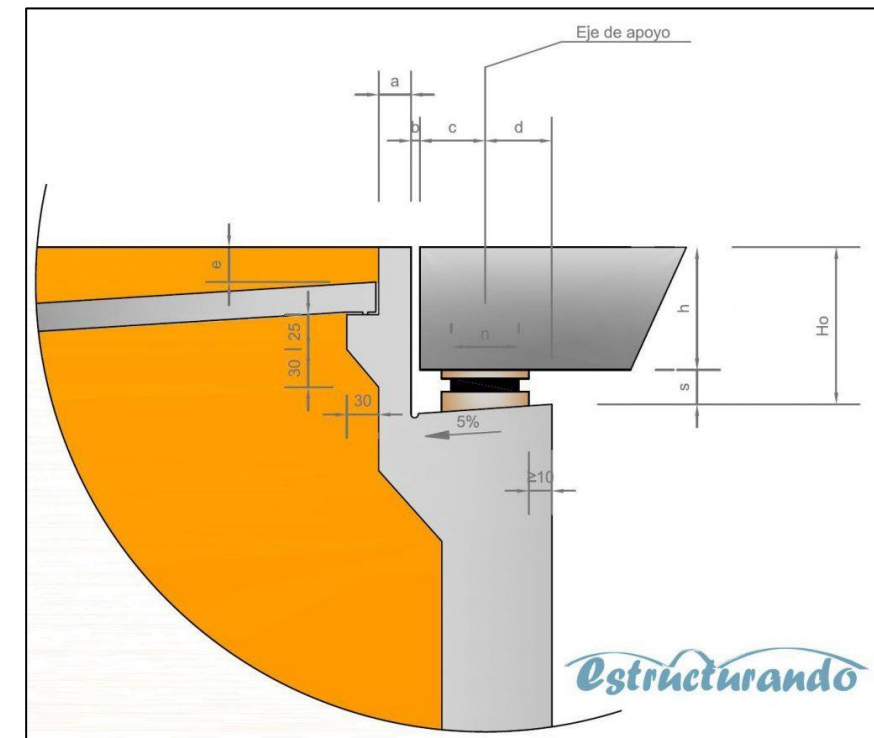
Estribo cerrado de puente con algunas cotas indicadas. Fuente: estructurando.net
